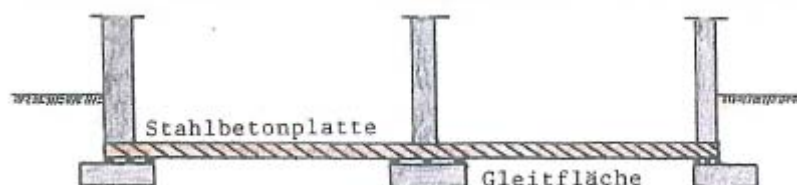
Abb. A Zerrungssicherung mit durchgehender Stahlbetonplatte
